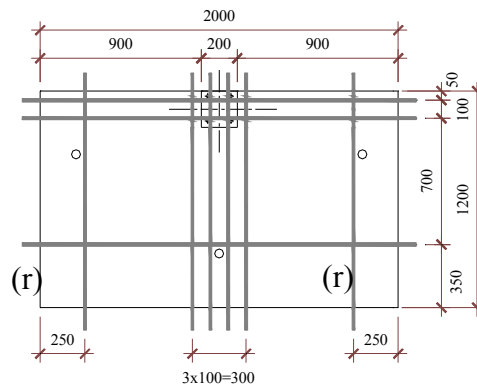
Armadura ativa – VILLAVERDE (2008).
